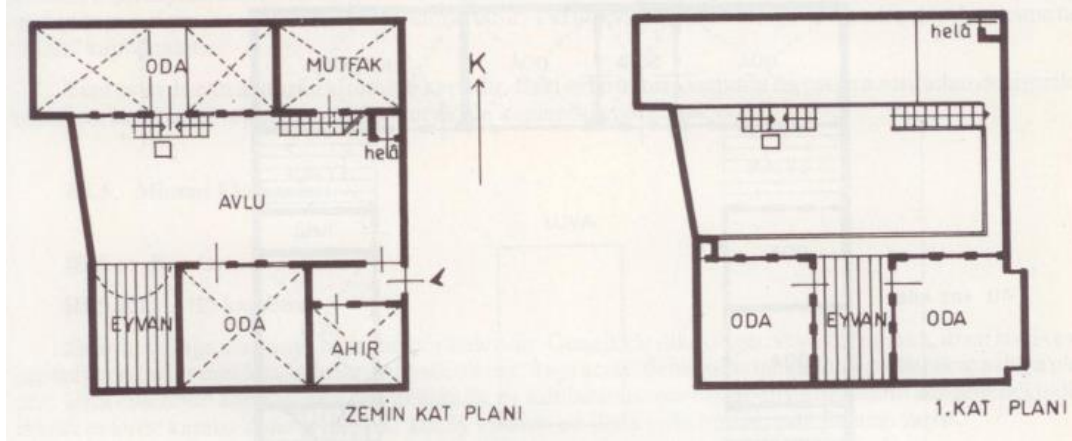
Eyvanın İki Adet Olduğu Ve Karşılıklı Planlandığı Plan Şeması (Karaçizmeli, 2011)
